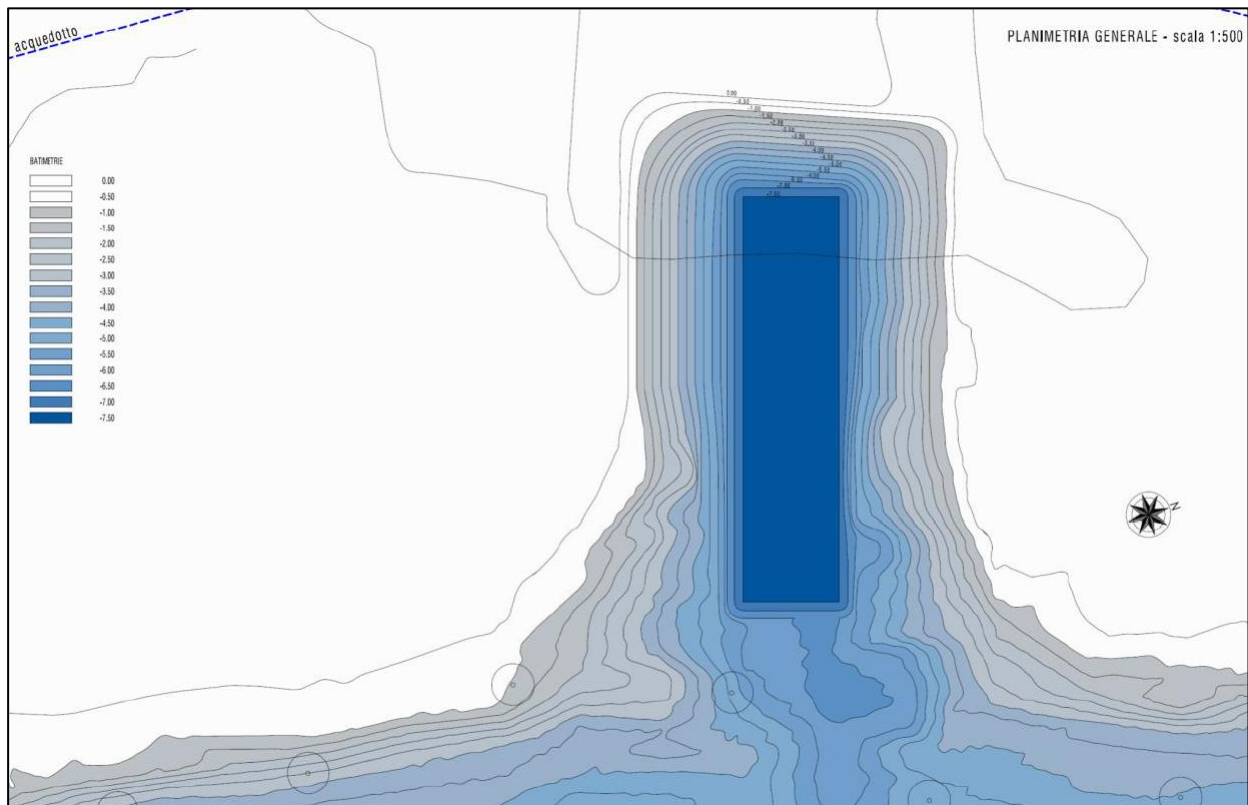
Estratto planimetria di progetto dell'intervento "Adeguamento degli spazi acquei esistenti degli ex Cantieri De Poli"
